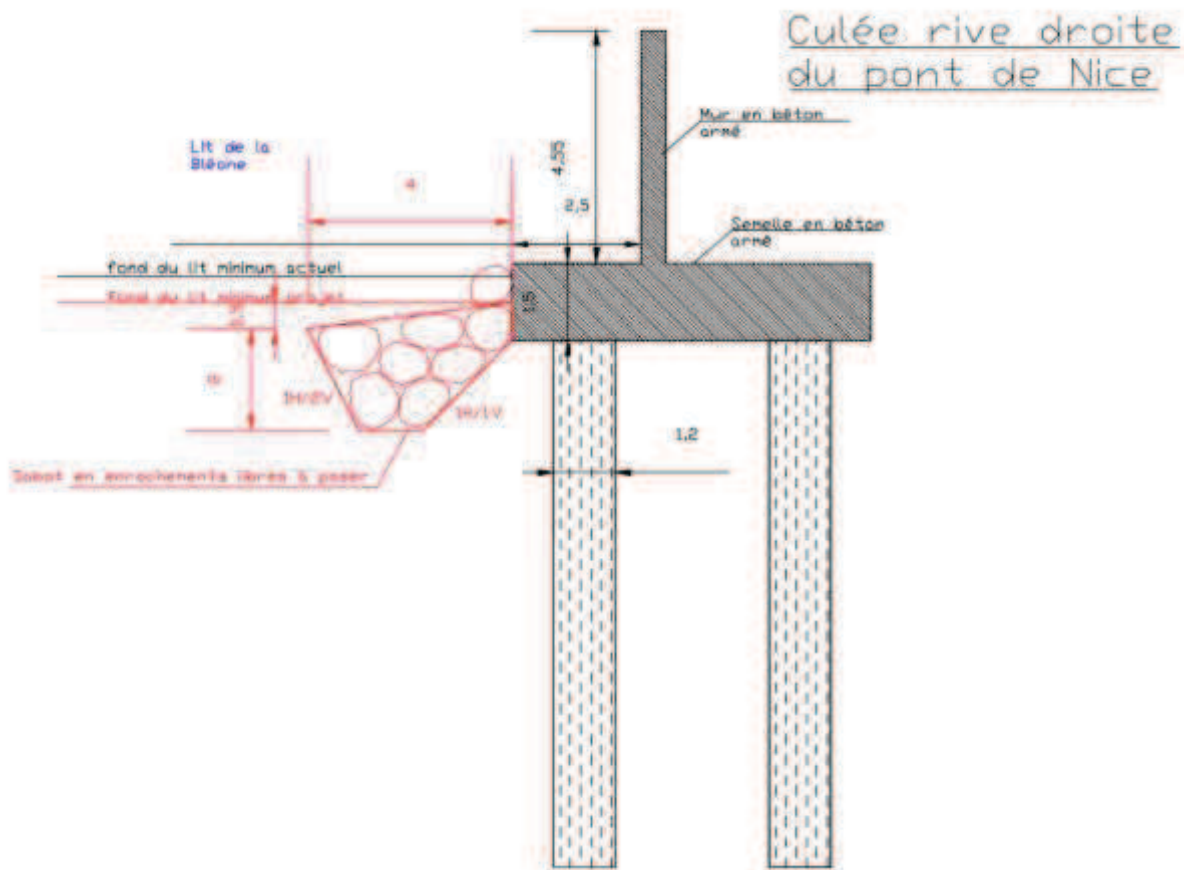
Coupe type des travaux dans le secteur du pont de Nice.
